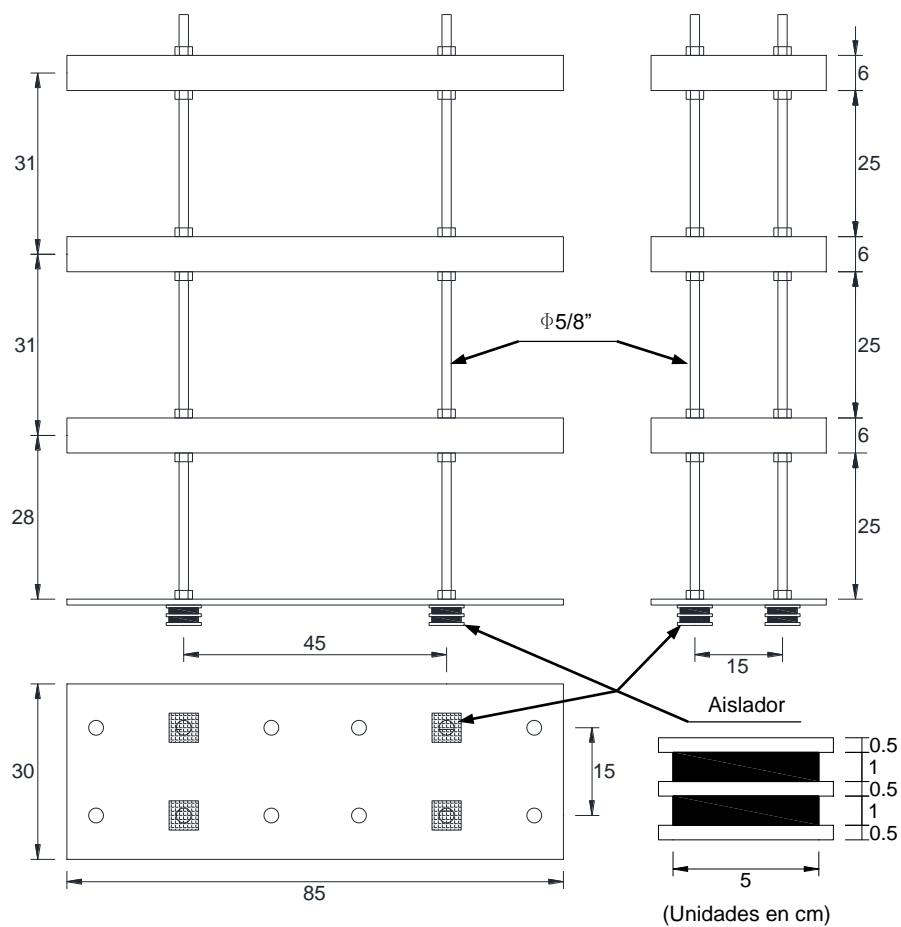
Detalles del espécimen de tres pisos y sistema de aislamiento
